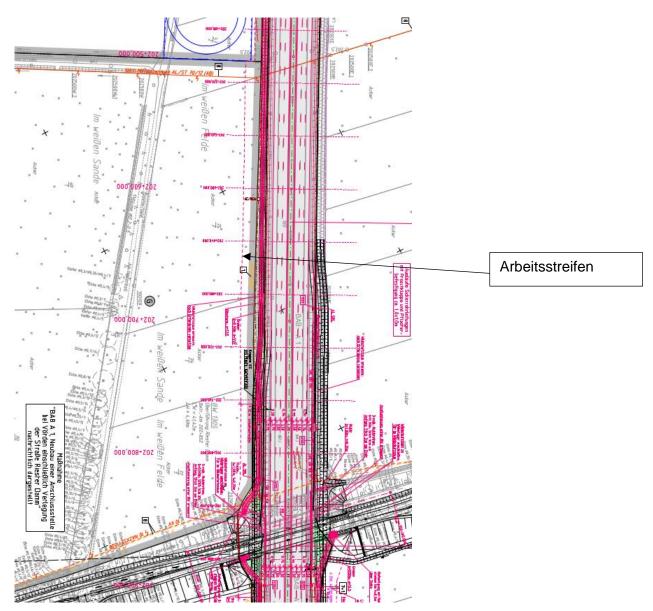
Dipl.-Ing. Dieter Linz GmbH & Co. KG, Wunstorf: Sechsstreifiger Ausbau der BAB A 1: Lageplan, Unterlage 5, Blatt 25 c, Stand 07/2017
